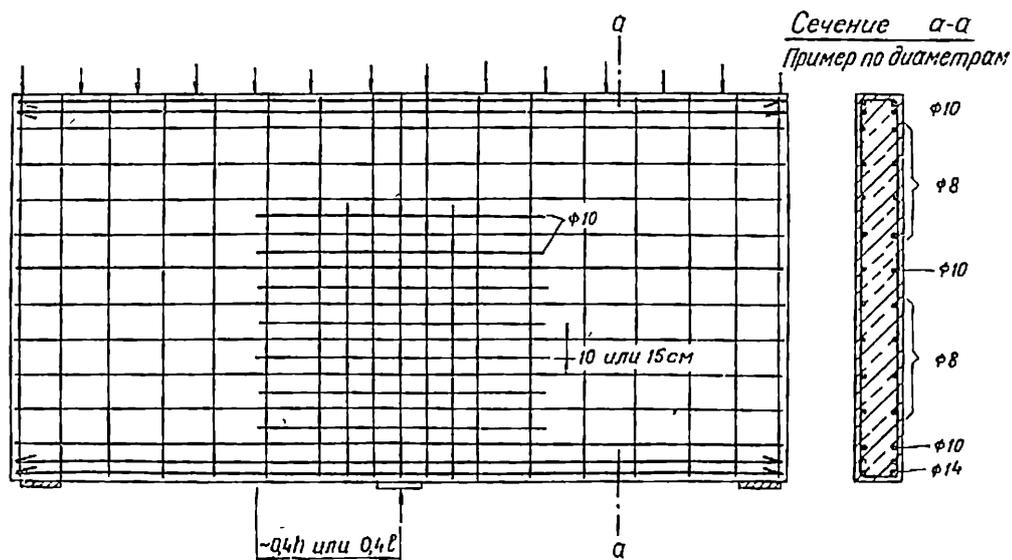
6. Армирование многопролетной балки-стенки ($l/h = 1$)
